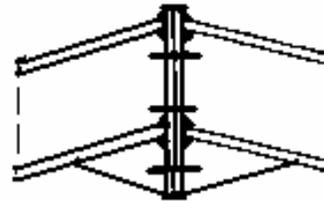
Assemblage poutre-poteau avec renfort par jarret
